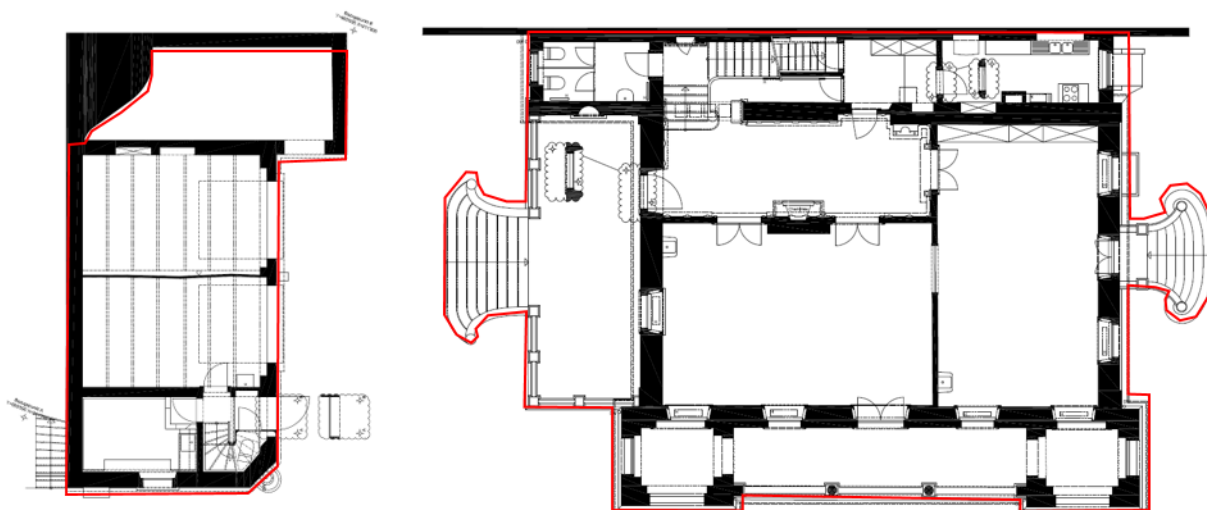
Das Baurechtsgrundstück umfasst den Fussabdruck der Gebäude (rot). Links: Remise, rechts: Villa Auf Musegg 1
